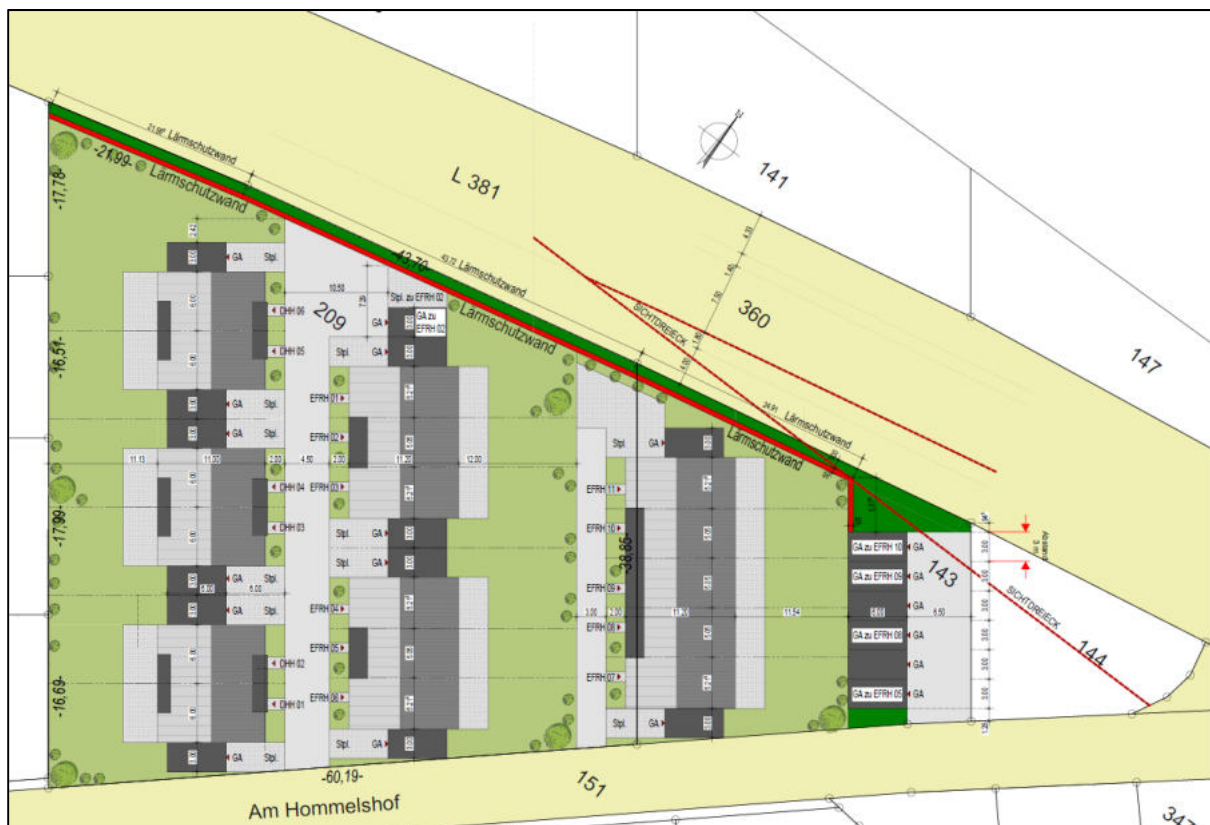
Lageplan Stand 24.05.2018 – Erster Planungsansatz mit schalltechnisch ungünstiger Gebäudeanordnung
